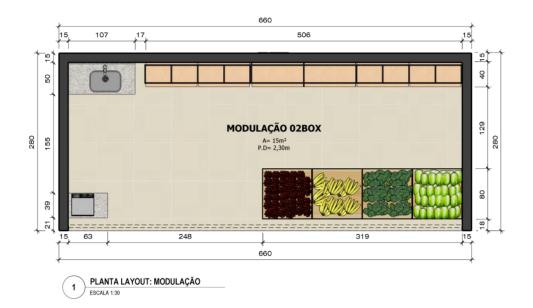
PLANTAS DE LAYOUT: MODULAÇÃO DE 02 BOXES
